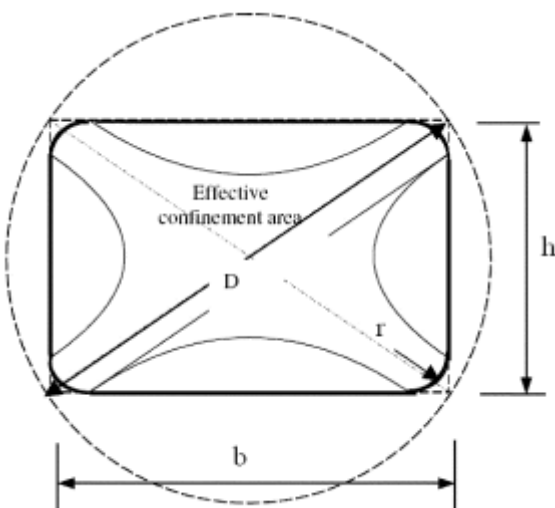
Sección Circular Equivalente en Sección Rectangular.
